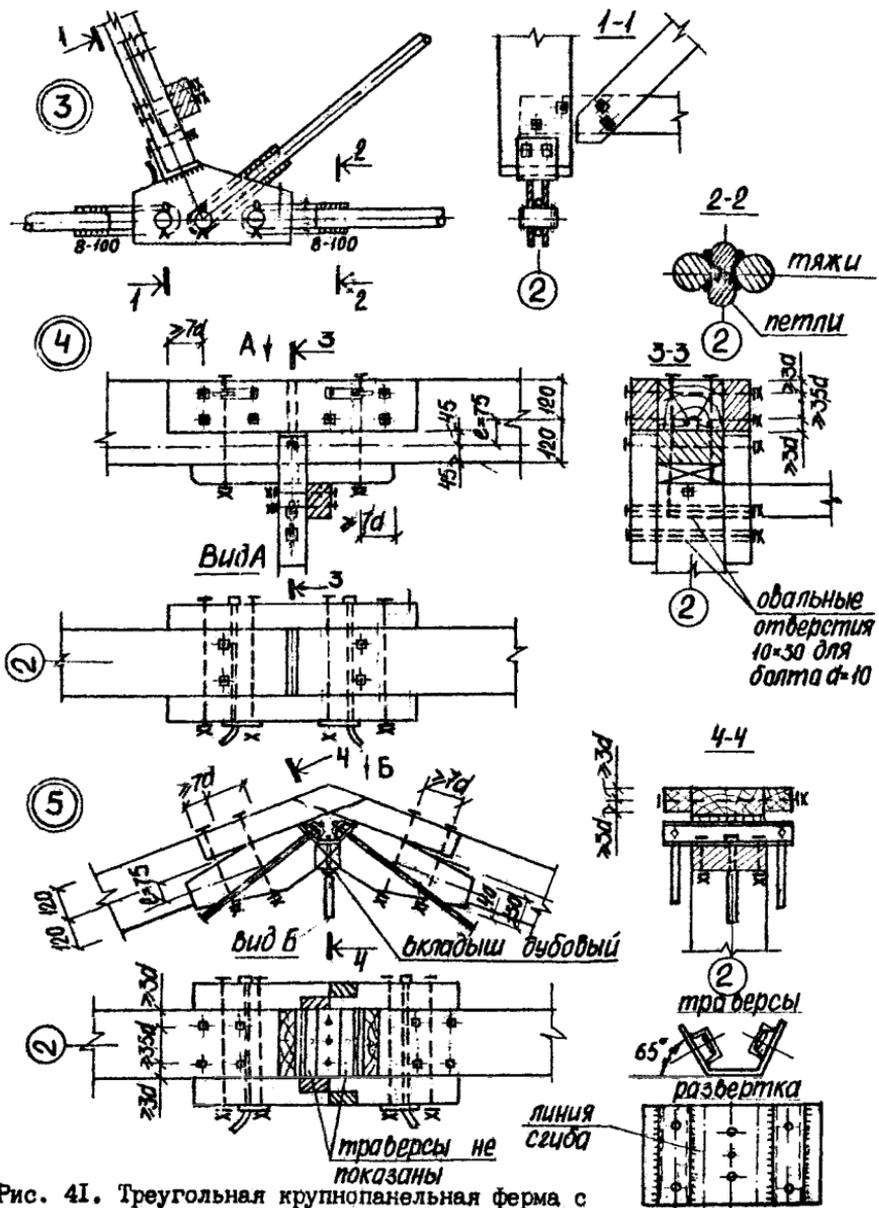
Треугольная крупнопанельная ферма с верхним поясом из цельных блоков
